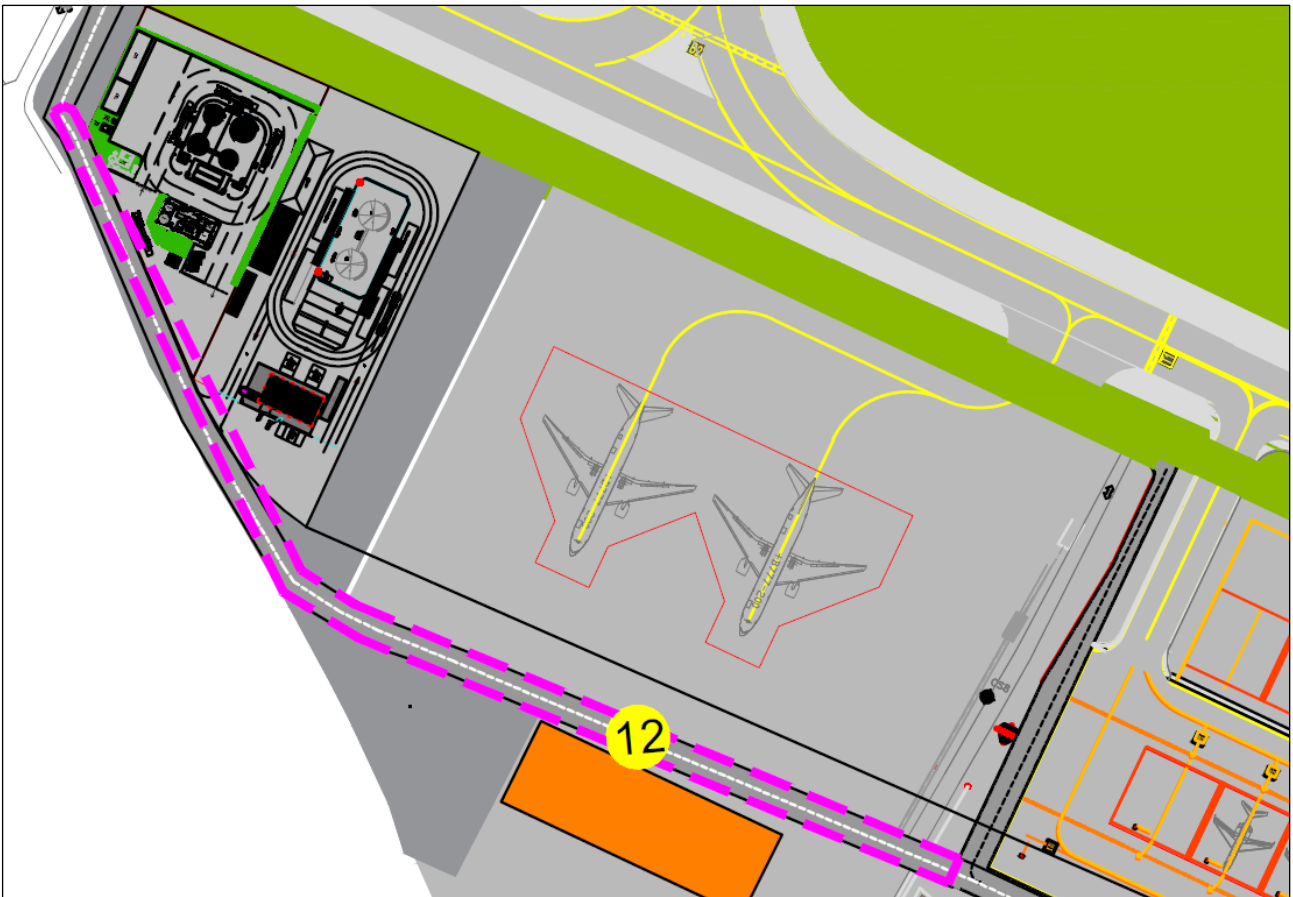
Estratto Master Plan – Nuova Viabilità Perimetrale
